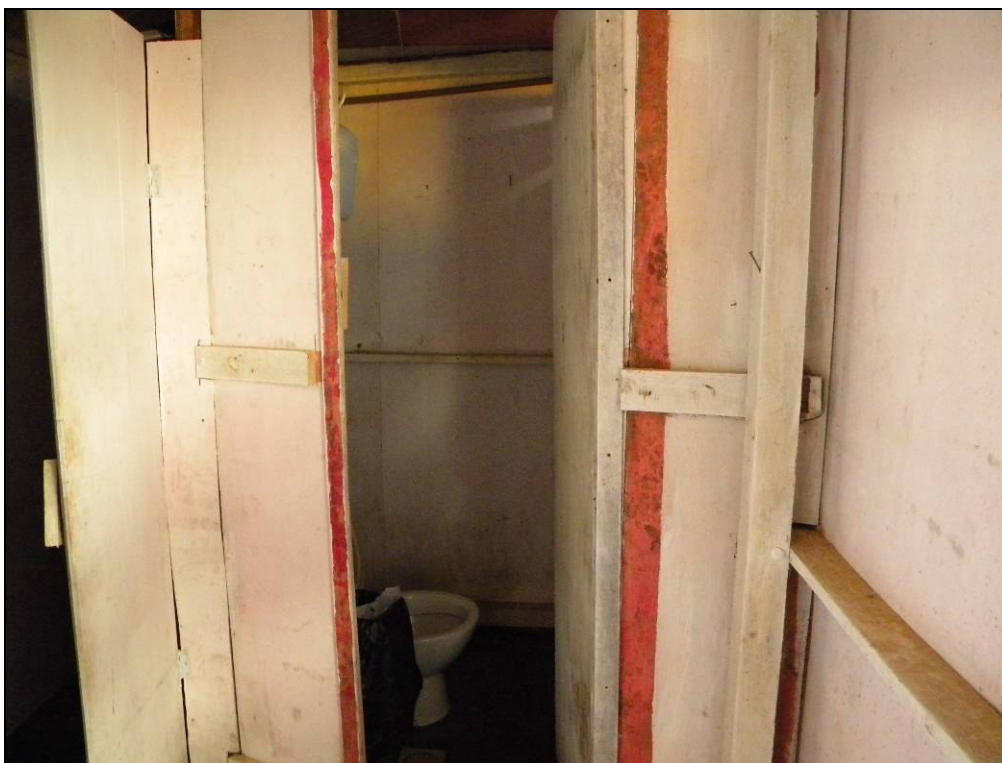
Banheiro da obra F (Obra Grande porte)
